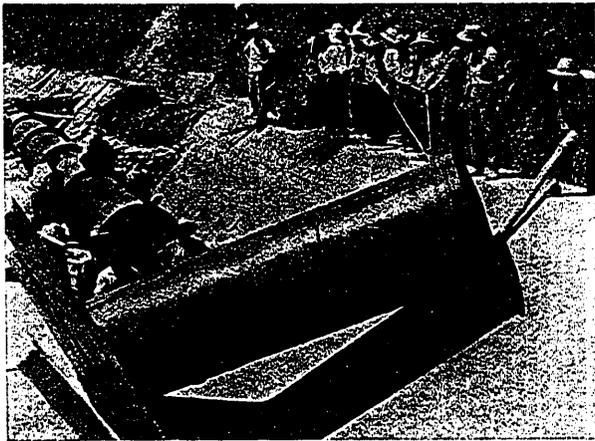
Bajada al Canal de la tubería de palastro y 1100 mm. de diámetro.
